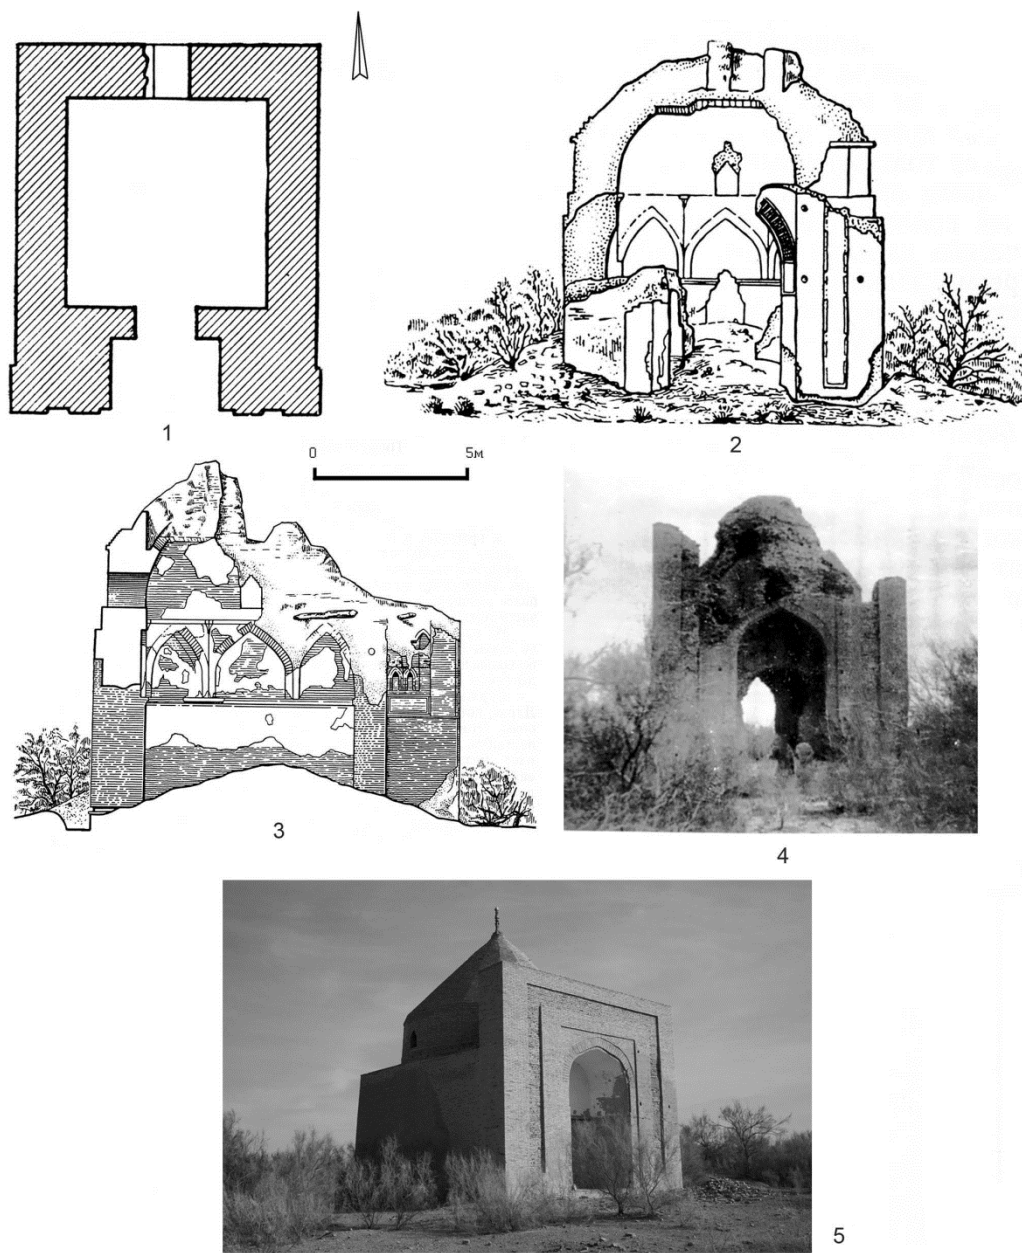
Мавзолей Сарлытам Жаныдарьинский: 1 – план; 2 – фасад; 3 – разрез [38];
